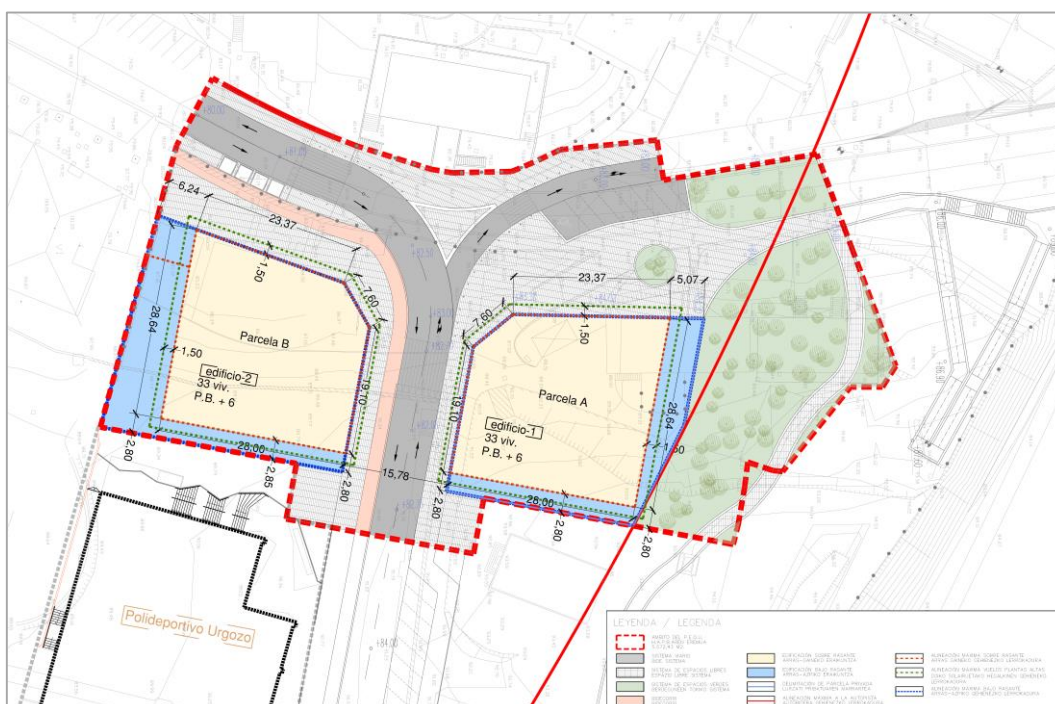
Ordenación pormenorizada de la propuesta de Modificación del PEOU de UE Karmen.
